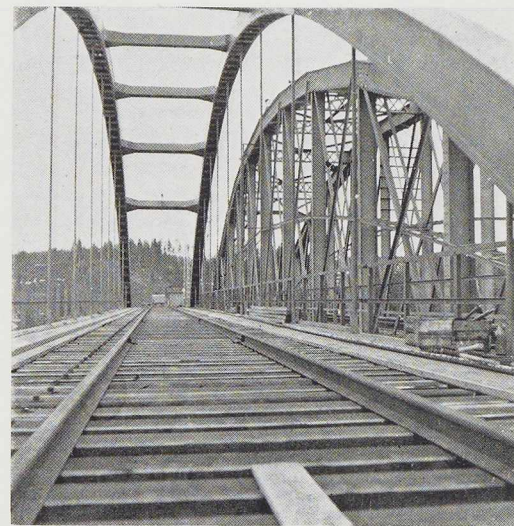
Contreventement supérieur à nœuds rigides d'un pont en arc raidi par poutres continues à âme pleine, construit récemment sur le réseau suédois.
